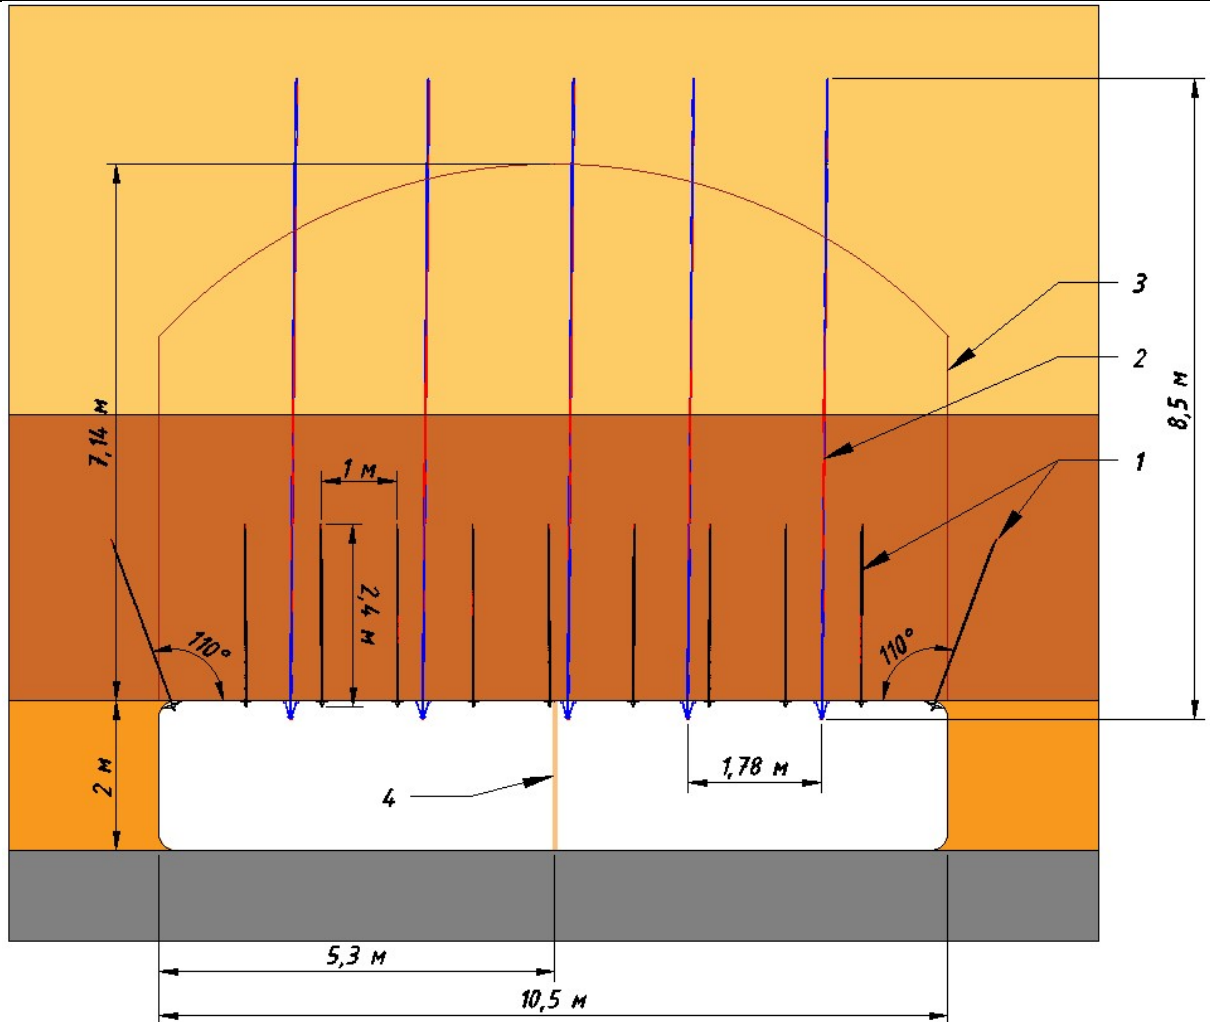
Поперечное сечение проводимой выработки: 1 – анкерная крепь 1-го уровня; 2 – анкерная крепь 2-го уровня; 3 – зона свода естественного равновесия; 4 – стойки усиления
